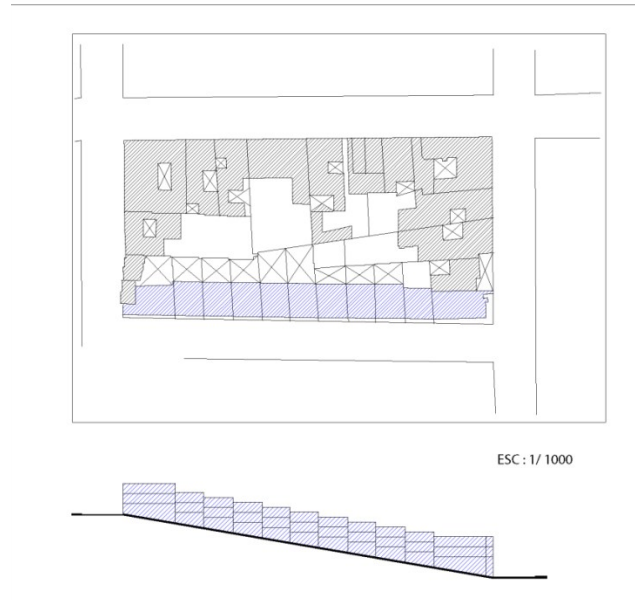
perfil sobre la carrera 11 entre calles 16 y 15 a, manzana 178, elaboración propia 2008.
